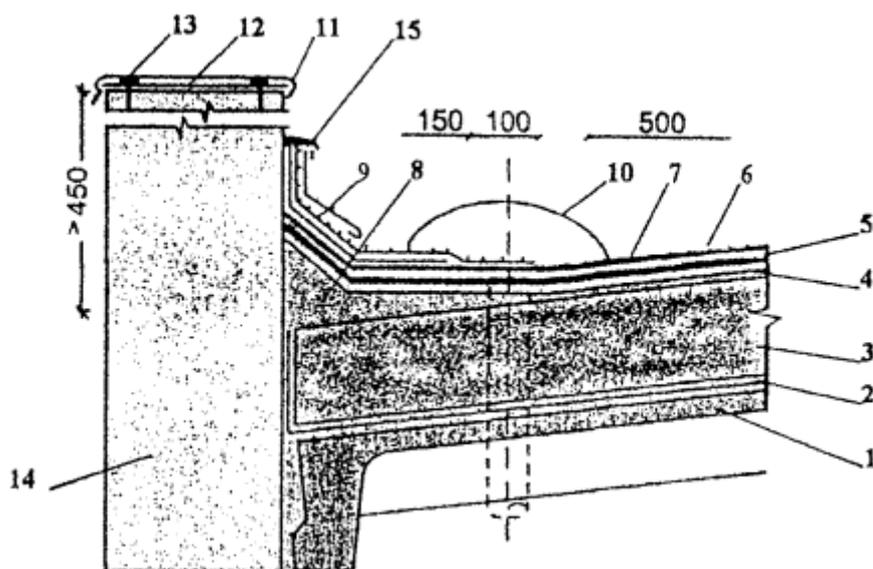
Примыкание кровли к парапету высотой более 450 мм: 1 - сборная железобетонная плита покрытия; 2 - пароизоляция (по расчету); 3 - теплоизоляция; 4 - выравнивающая стяжка; 5 - нижний слой основного кровельного ковра; 6 - верхний слой основного кровельного ковра; 7 - крупнозернистая посыпка; 8 - наклонный бортик; 9 - слои дополнительного кровельного ковра; 10 - воронка внутреннего водостока; 11 - оцинкованная кровельная сталь; 12 - костыли 40×4 через 600 мм; 13 - дюбели; 14 - стена; 15 - герметизирующая мастика
